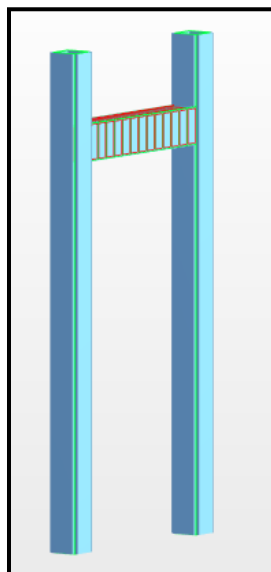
Eixo dos pilares vazados e seção caixão (Arquivo do Autor).
